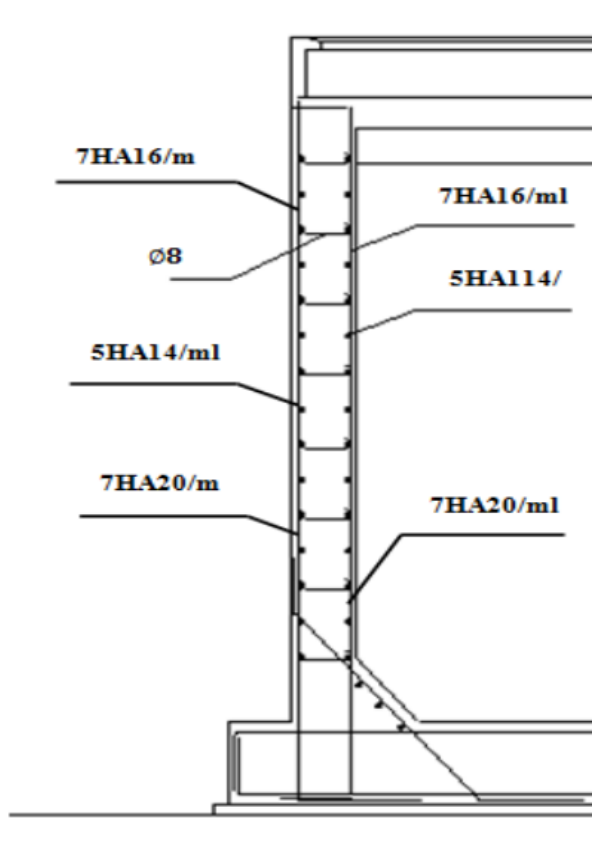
Ferrailage des voiles extérieurs en travée coupe (Z-Z').
